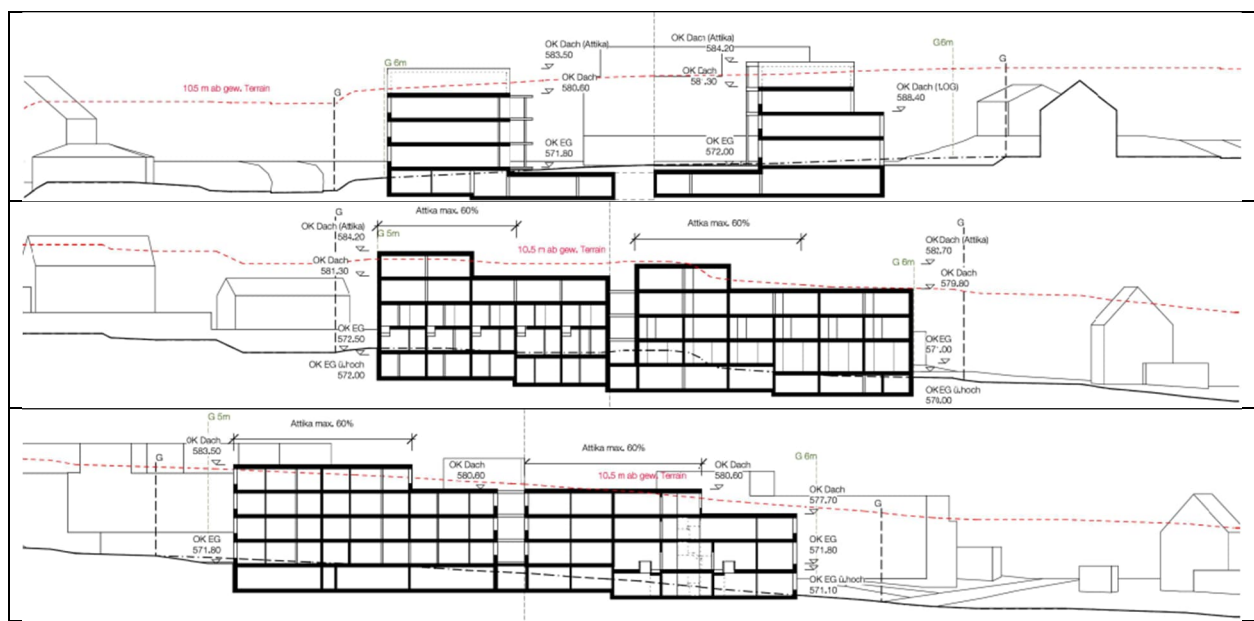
Schnitte aus dem Richtprojekt: a) Querschnitt Haus 2b und 1b; b) Längsschnitt Haus 1a und 1b; c) Längsschnitt Haus 2a und 2b (Quellen: Quellen: Darlington Meier Architekten AG, 11.12.2019)
